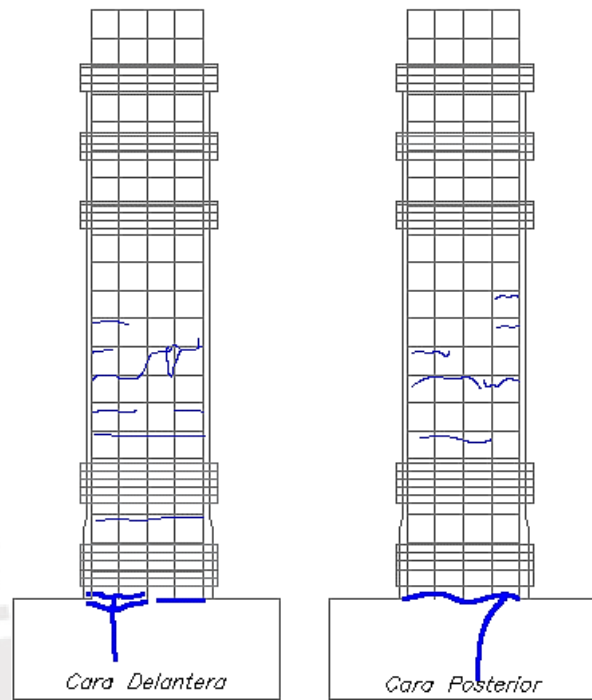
Mapa de fisuras de la viga VM-02
